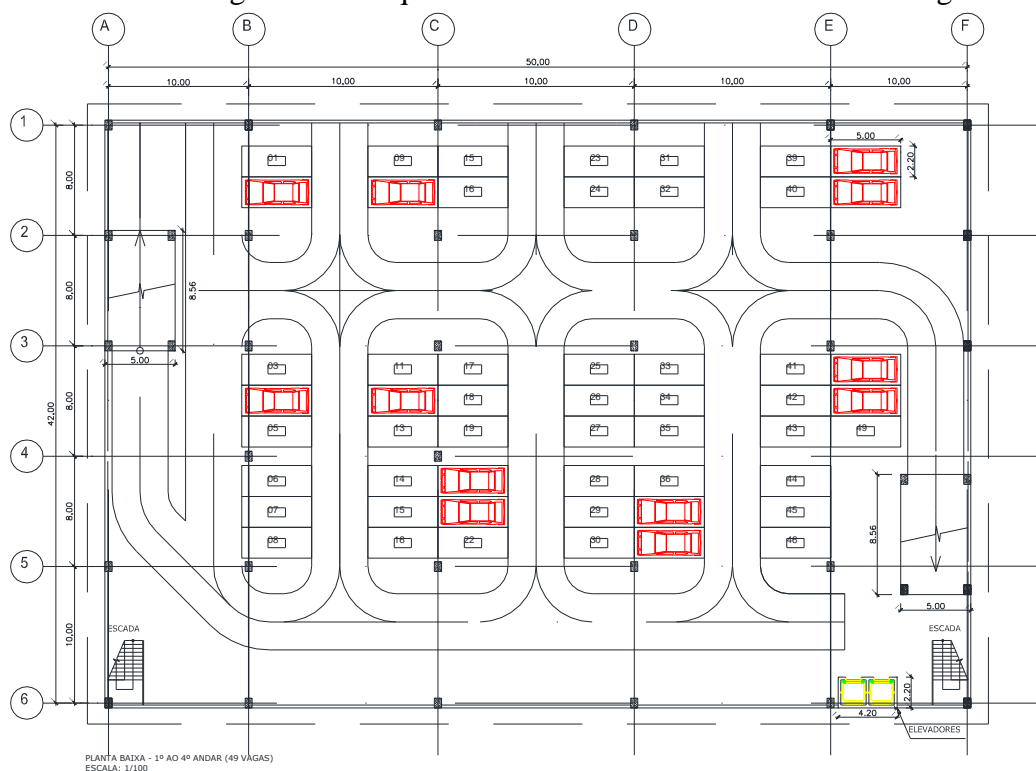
Arquitetura – Planta Baixa do 1º ao 4º andar – 49 vagas
